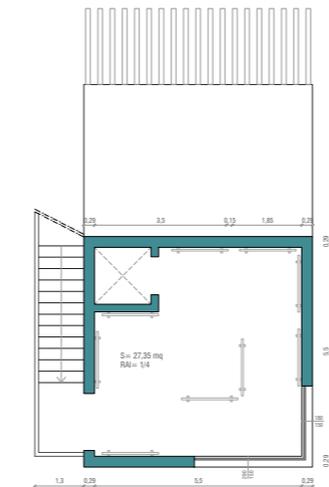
Pianta piano primo. Scala 1:200
